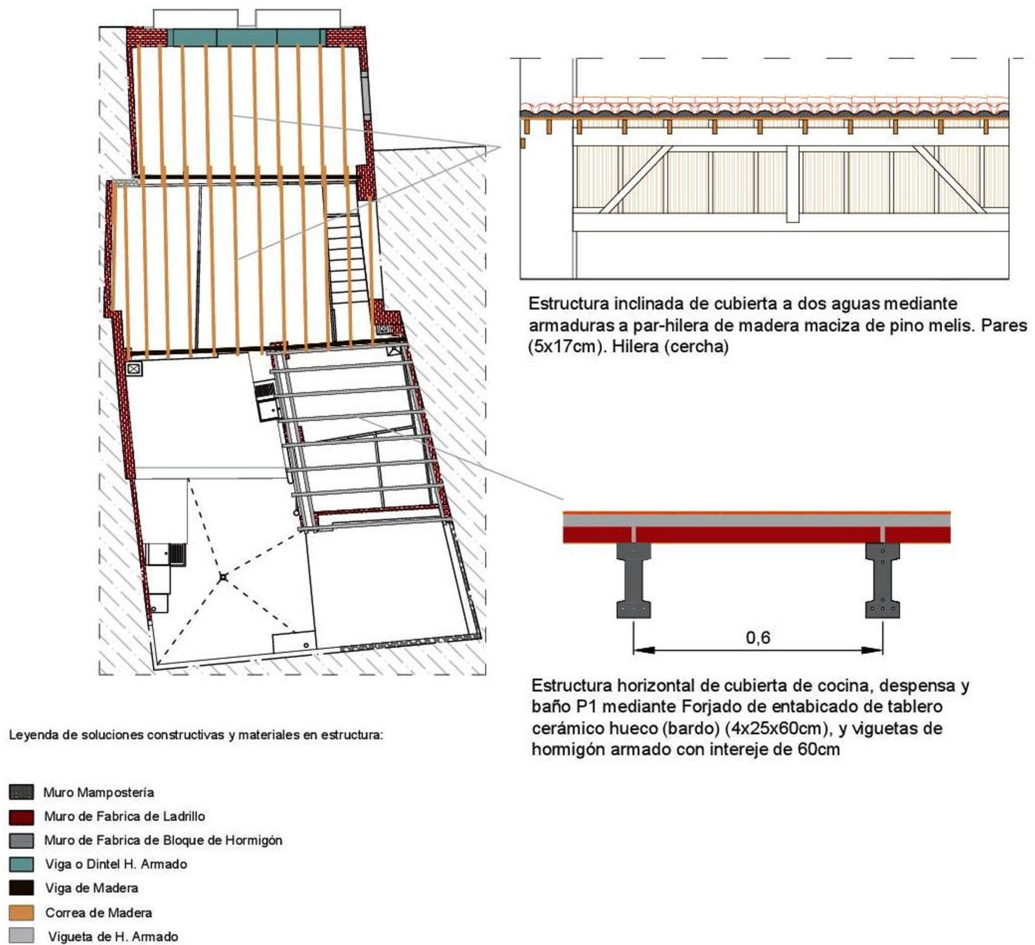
Tipos de forjados y estructuras de cubierta en Planta 1ª
